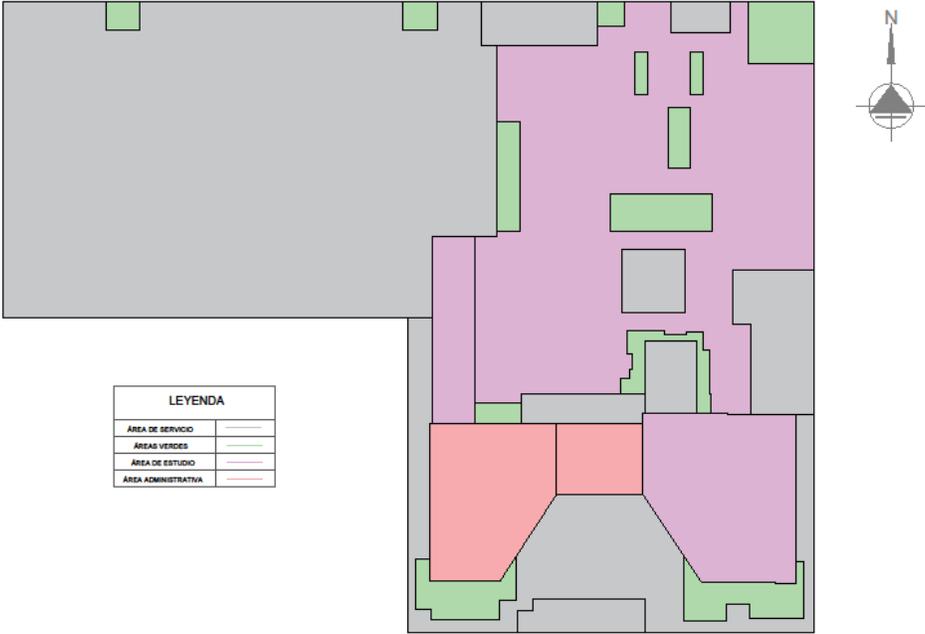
Zonificación de la Planta Baja del Centro Tecnológico Digital
